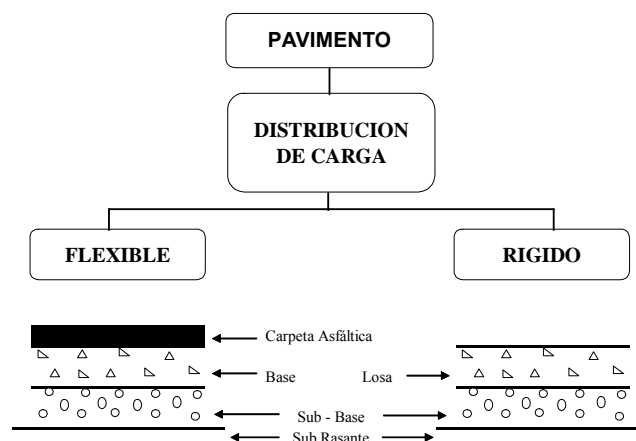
Capas requeridas por diferentes estructuras de pavimentos (e.p.)
